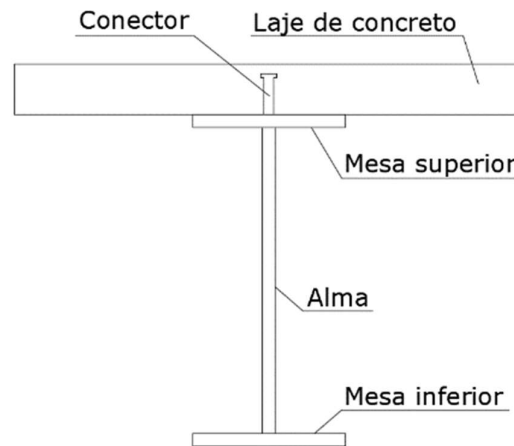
Partes que constituem a viga mista aço-concreto.
